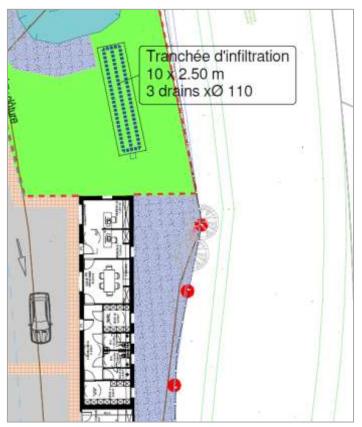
Tranchée d'infiltration des eaux pluviales de toiture
